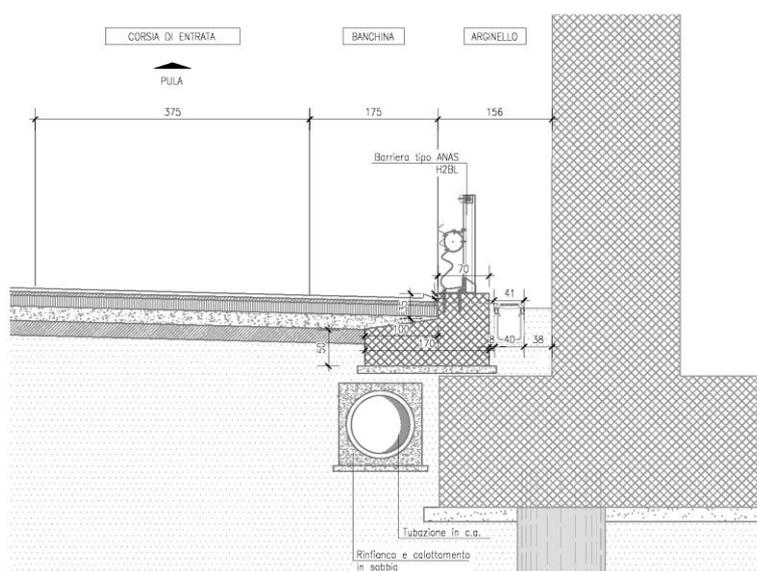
Protezione di progetto rampe tratti bordo laterale in sterro in affiancamento svincolo Saras
